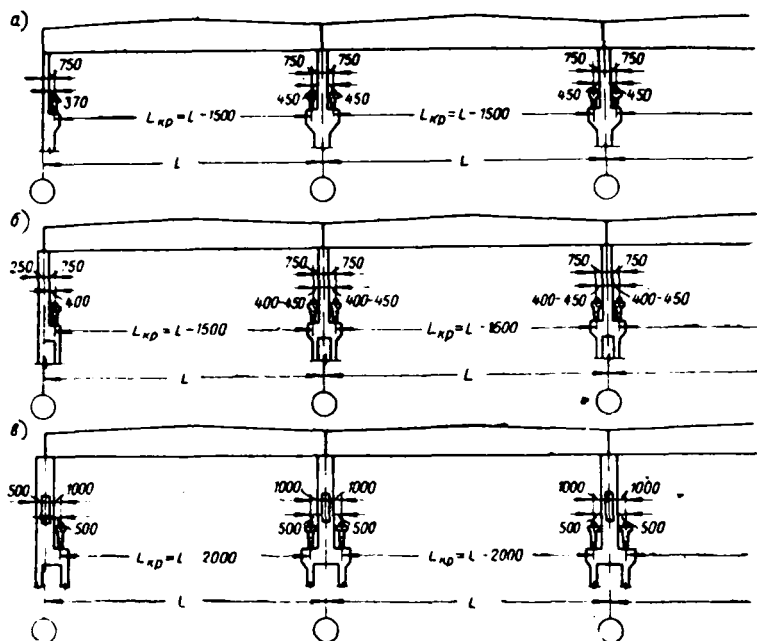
Привязка подкрановых балок к продольным разбивочным осям
